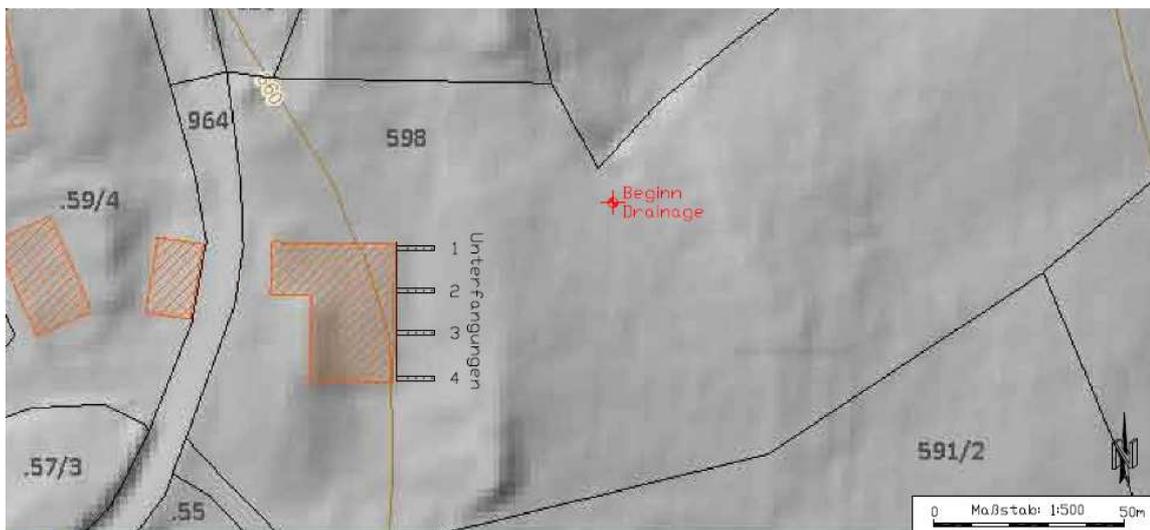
Lageplan mit der Darstellung der vier Unterfangungsscheiben, angebunden an das Wohngebäude²⁶²
